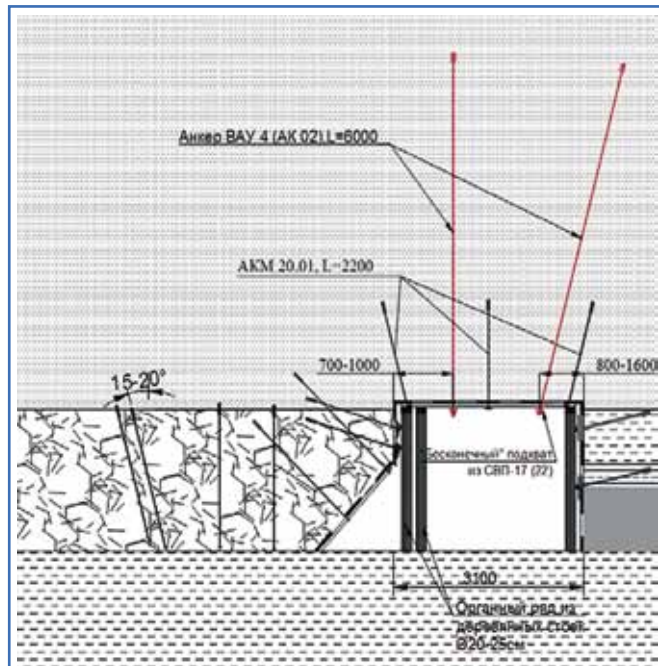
Обрушение кровли после первичной посадки и сохранение монтажной камеры (сечение)
